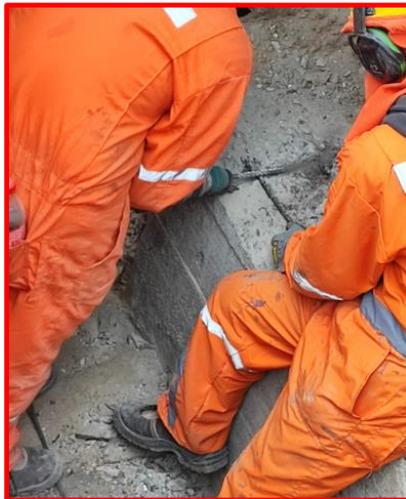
Hallazgo de masa de hormigón externa a la fundación F1.
